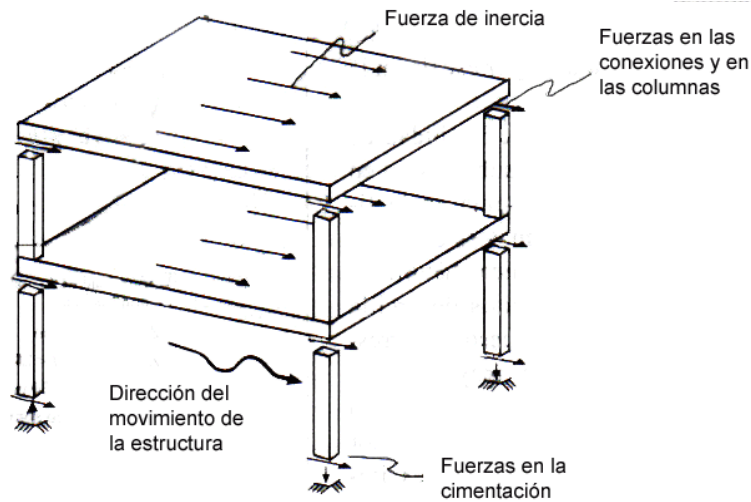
Flujo de fuerzas en la estructura debido a la vibración.
